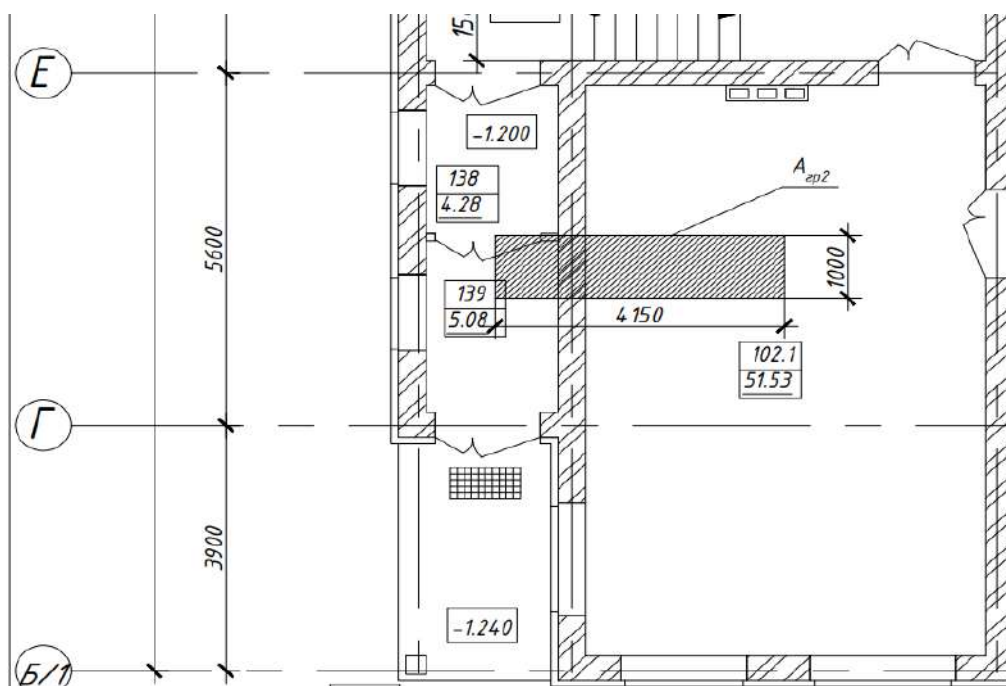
Фрагмент плана с грузовой площадью для фундаментов, расположенных в осях 2ГЕ (b=1.4м)
